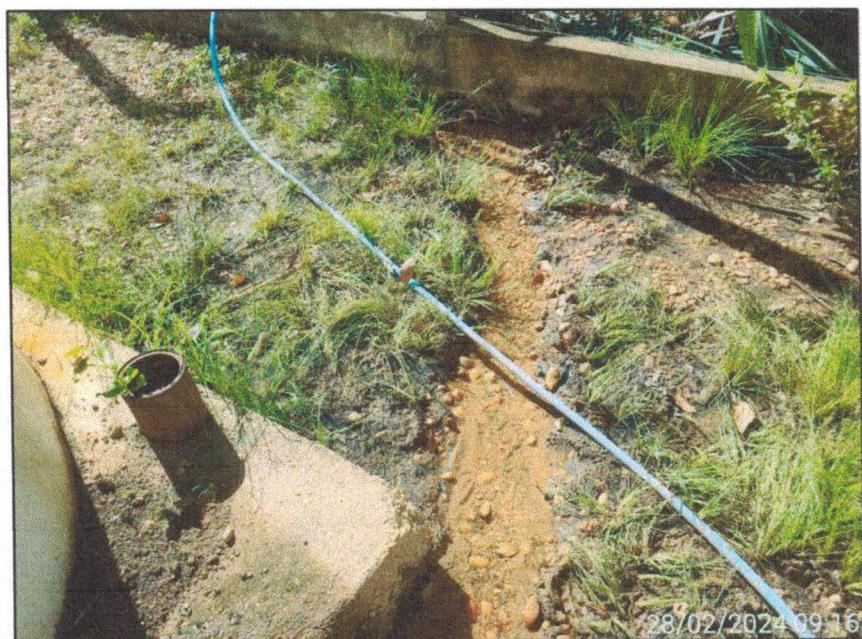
Detalhe do local de passagem do vazamento da água filtrada.
